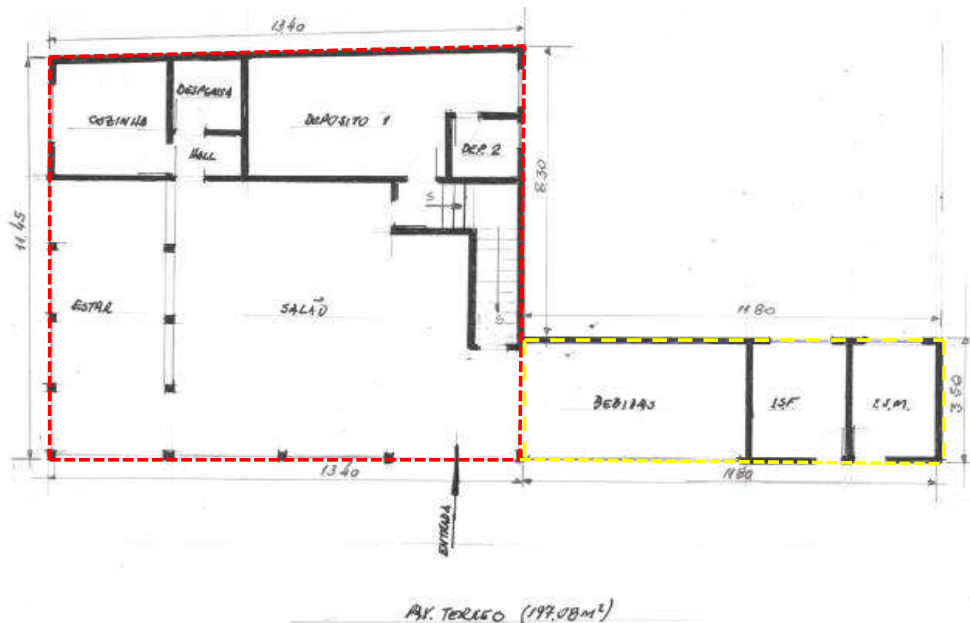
Croqui esquemático representando o pavimento térreo da edificação em dois pavimentos, com área aproximada de 197,08 metros quadrados, construída em duas etapas. Área com perímetro destacado em vermelho refere a fase 1 da construção do prédio e a área em amarelo a fase 2.
